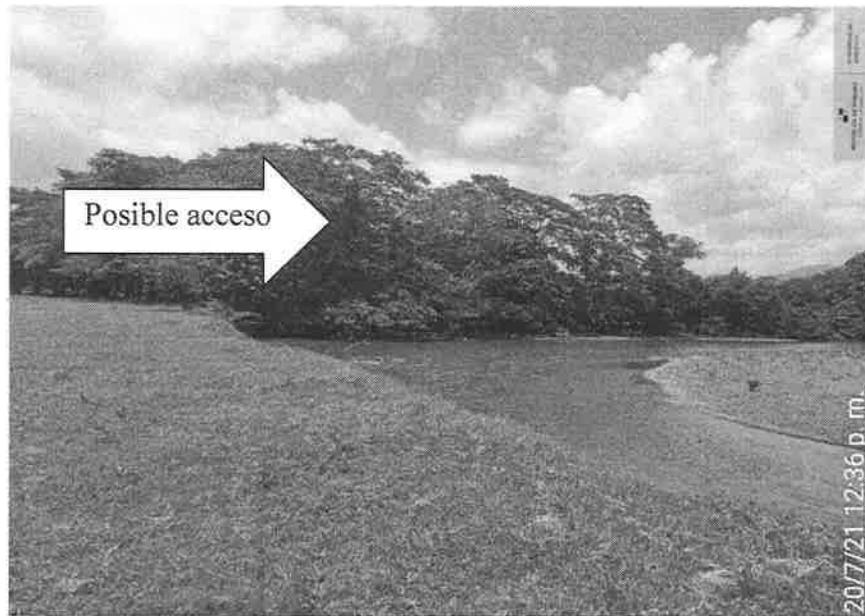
Vistas de posible acceso para extracción Fuente: Inspección realizada el 20/7/2021.
